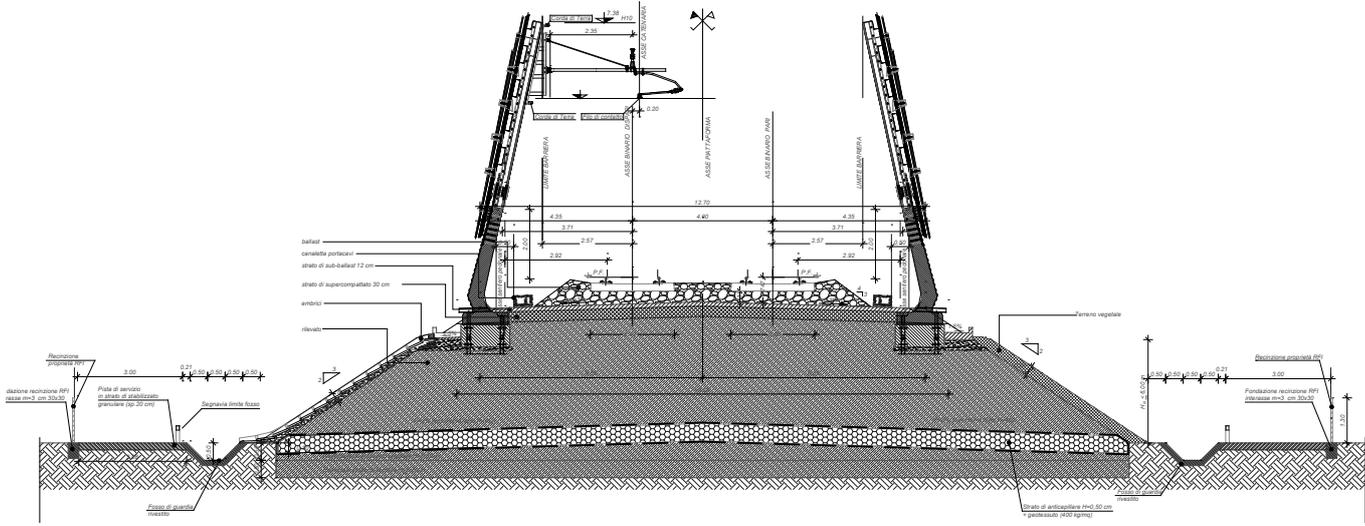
Sezione tipo ferroviaria in rilevato a doppio binario con BA tipo “HS”
